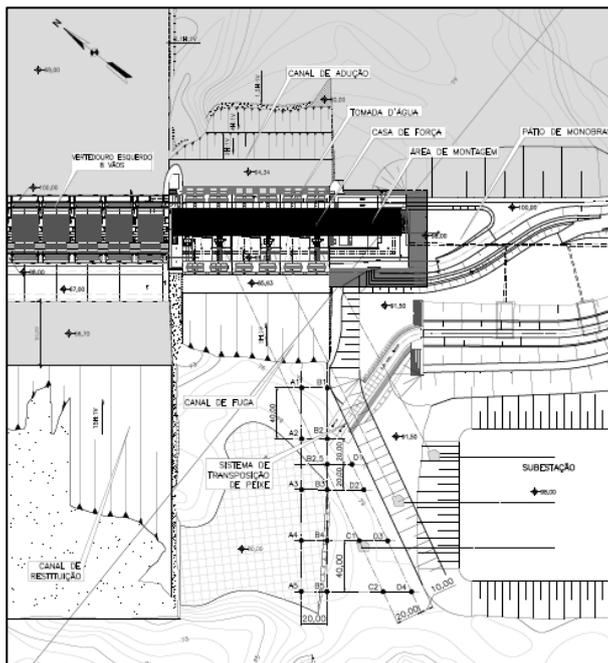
3a – Arranjo em planta da Alternativa Final para dique junto à entrada do STP (Anexo 2, LEME (2012a)).
